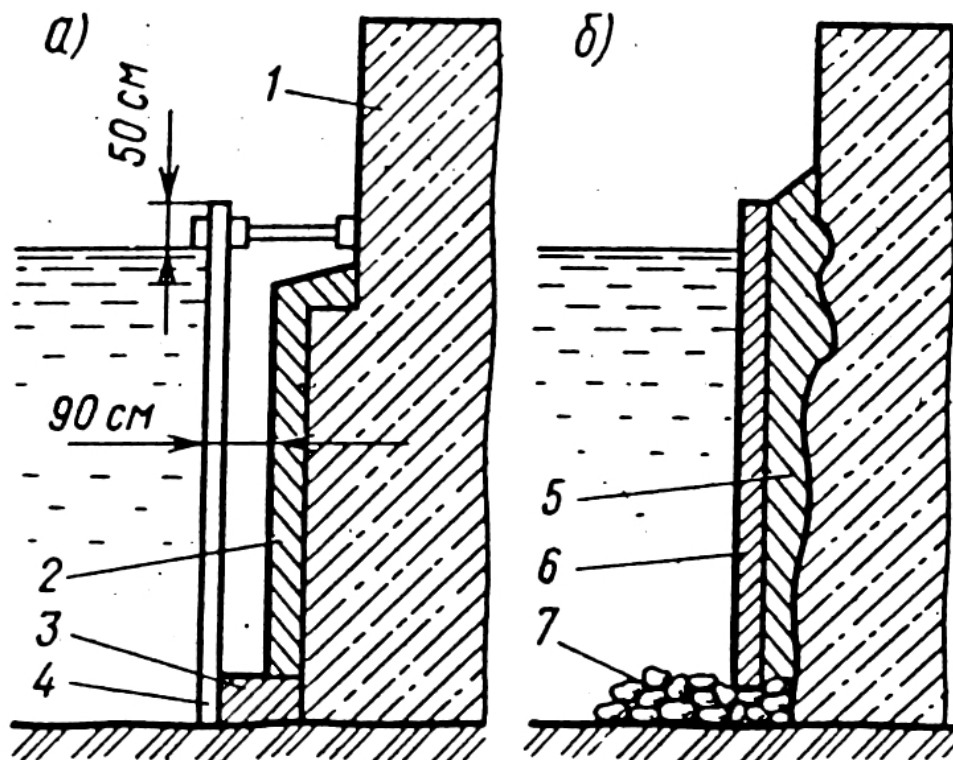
Схема устройства защитной железобетонной оболочки для подводной части опоры: а – с применением шпунта и откачкой воды; б – с применением бетонного ящика без откачки воды; 1 – кладка опоры; 2 – железобетонная оболочка; 3 – тампон из подводного бетона; 4 – шпунтовая перемышка; 5 – бетон заполнения пазух подводным способом; 6 – железобетонная оболочка ограждения; 7 – каменная отсыпка
